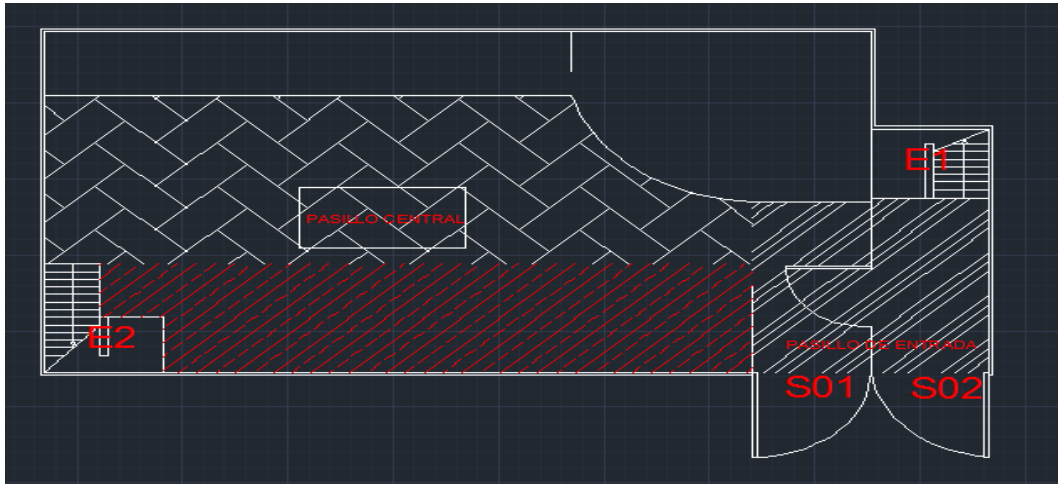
“Plano de la planta del primer piso de la discoteca 2 en formato DXF.”
